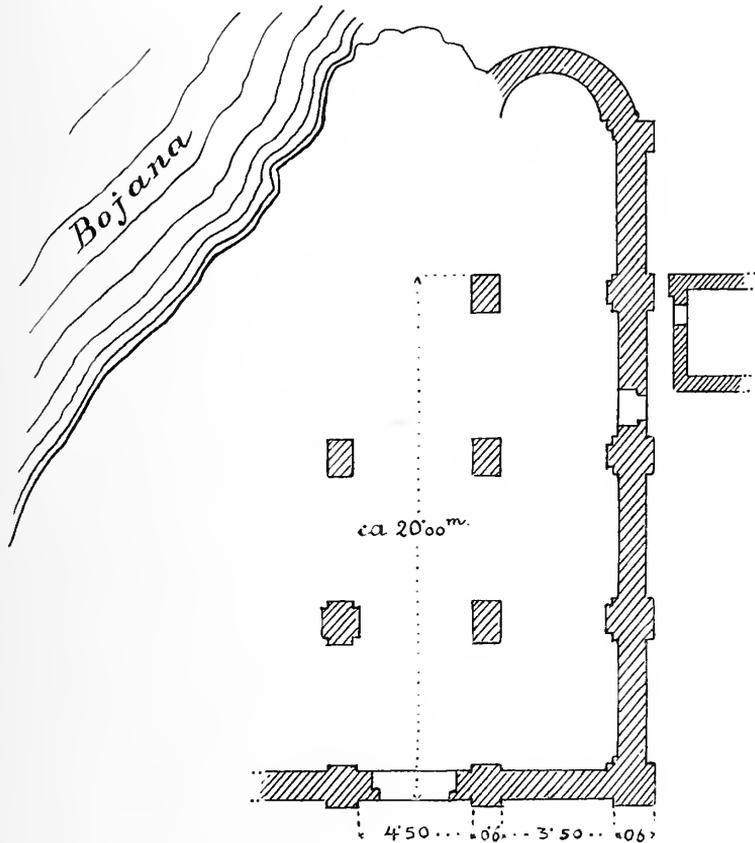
Grundriss der Kirchenruine von Širdzi.
